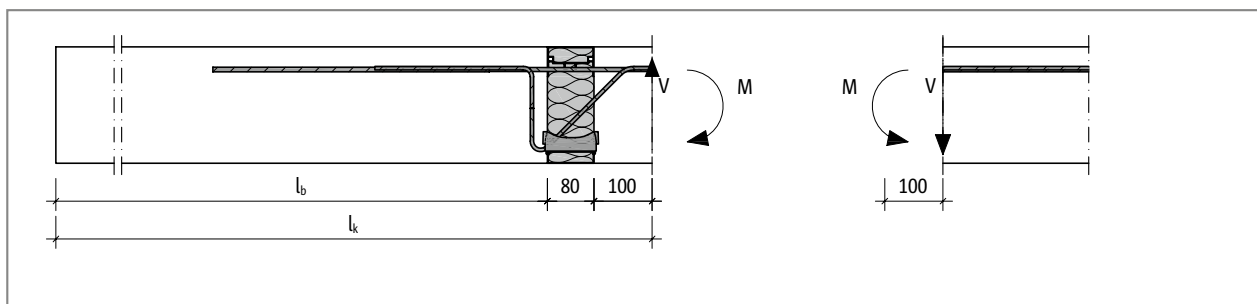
Schöck Isokorb® tipo K: dimensioni di sezione calcolate applicate al solaio
